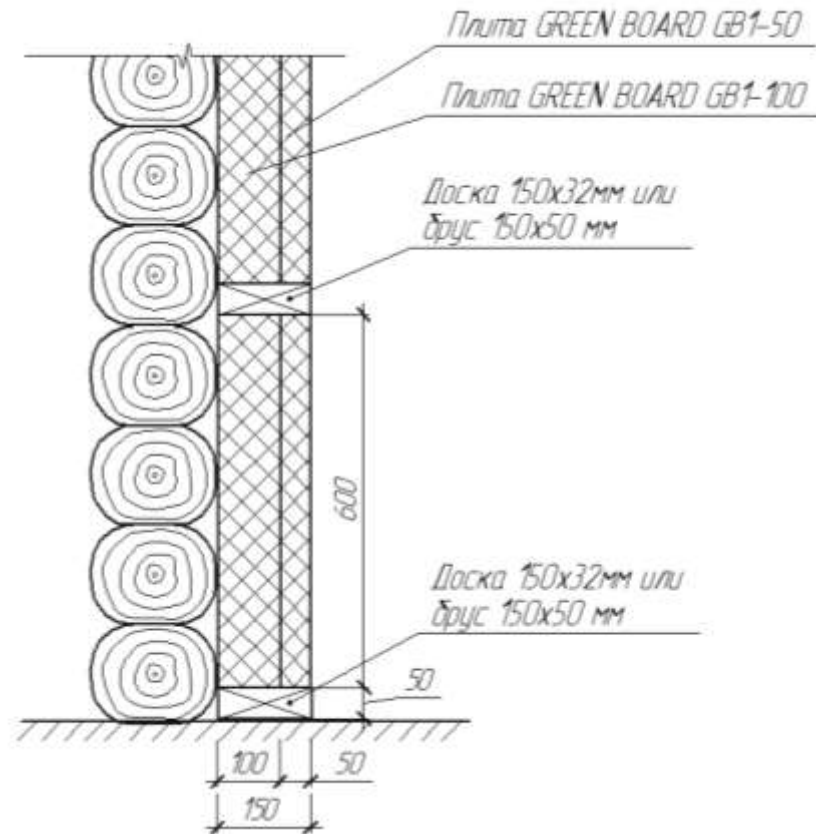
Разрез деревянной стены с установленным утеплителем – плитами GB1
